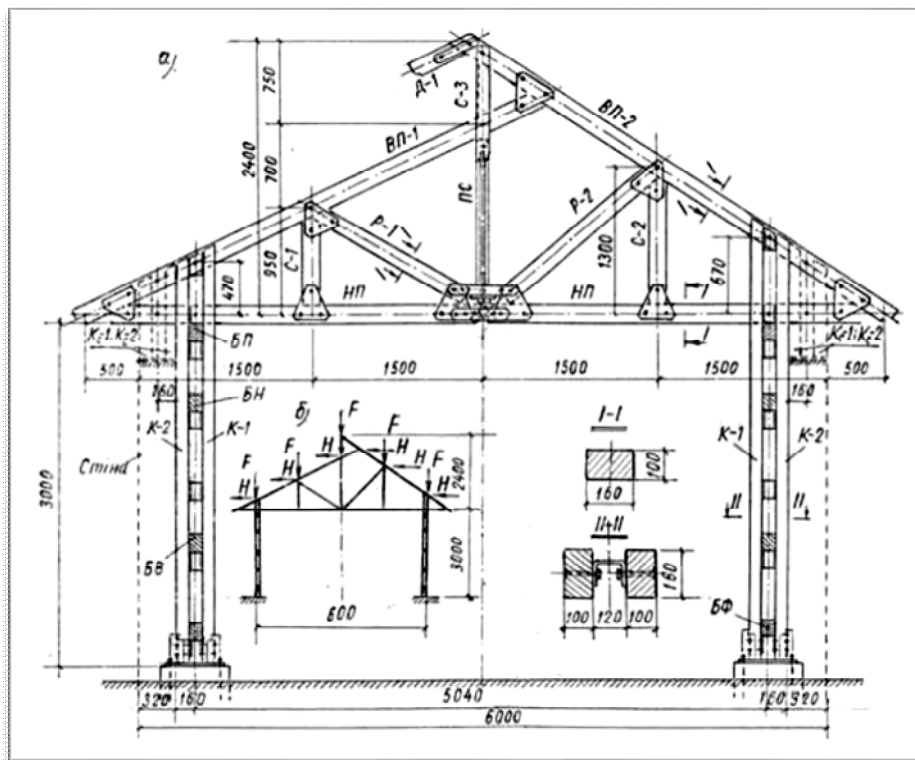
Дослідна конструкція рами каркасу одноповерхового будинку прольотом 6,0 м з однотипних збірних залізобетонних елементів перерізом 160×100 мм. К-1 і К-2 – збірні елементи двовіткових колон; БФ, БВ; БН і ПБ – фундаментні, віконні, надвіконні і підкроквяні балки стінових рам; НП; ВП-1; ВП-2; С-1; С-2; Р-1 і Р-2 елементи ригеля рами у вигляді трикутних ферм
